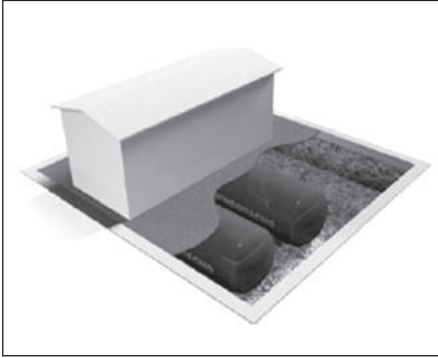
Схема размещения ТС «Газовик-ПО» с подземным расположением резервуаров
